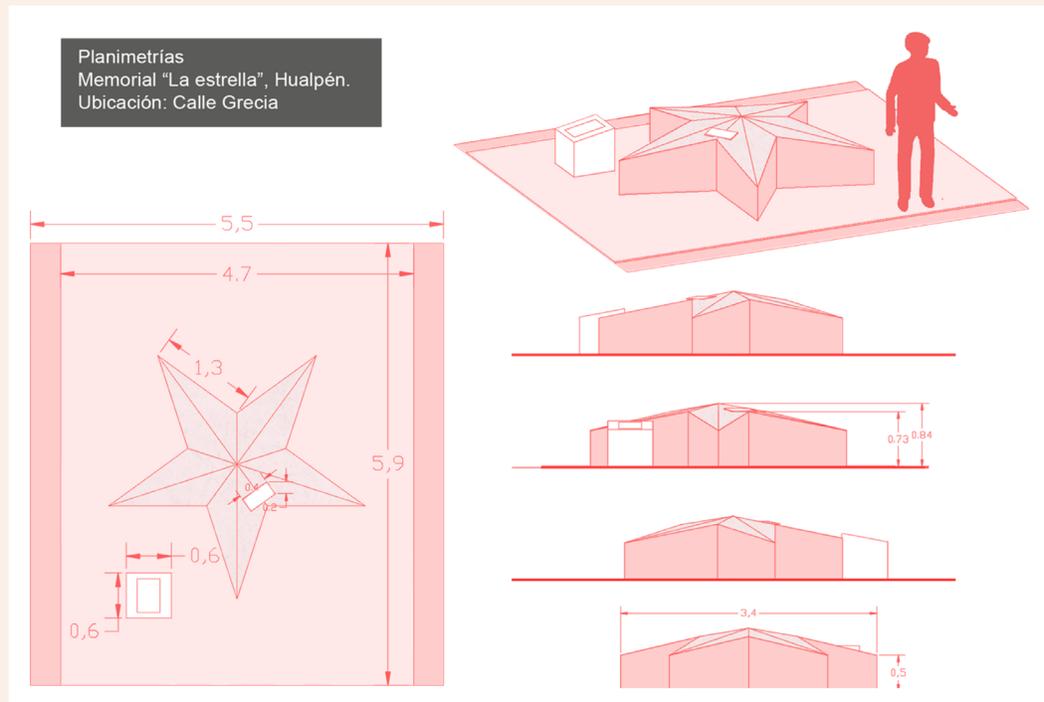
Planimetrías memorial "La estrella". Fuente: Elaboración propia
